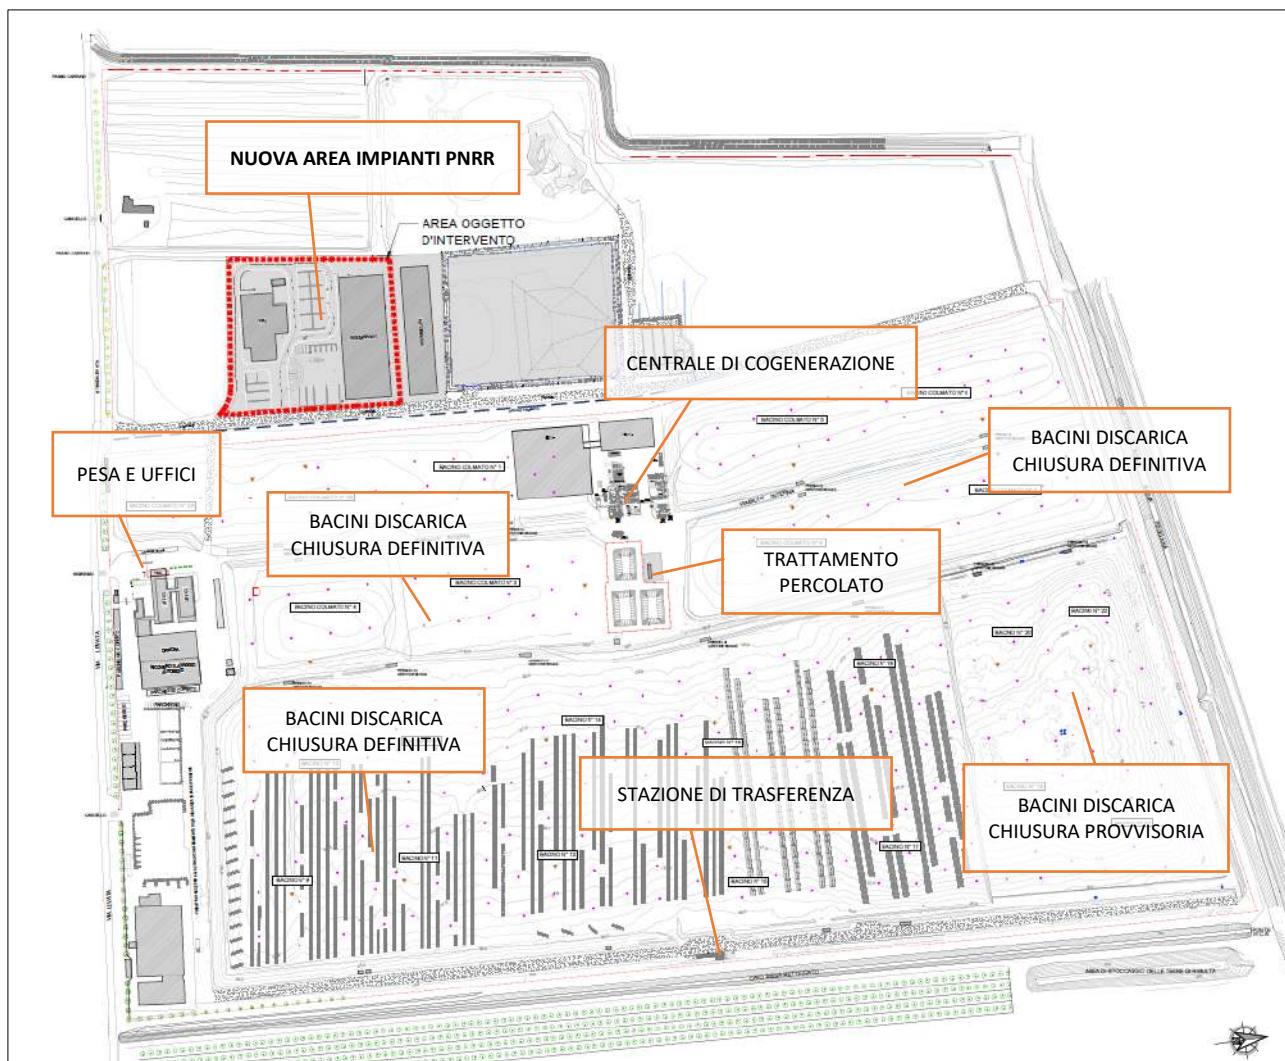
Planimetria generale con indicazione delle aree interessate al presente studio
